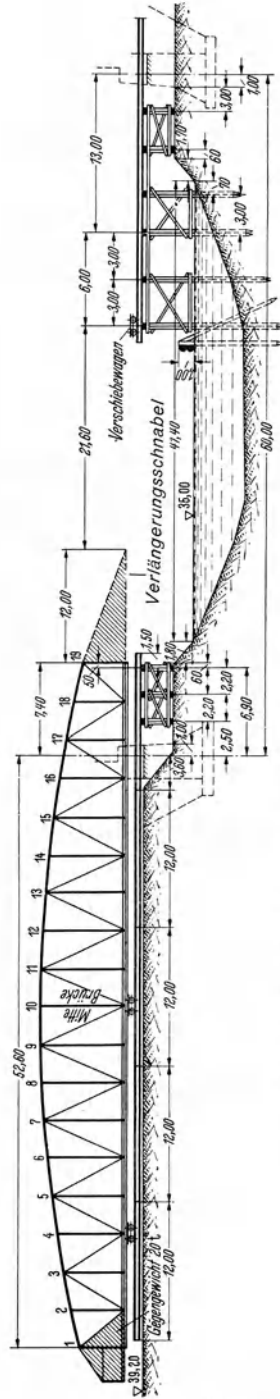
Längsverschiebung einer eingleisigen Eisenbahnbrücke über den Rhein-Herne-Kanal. (Der angesezte dreieckförmige Verlängerungsschnabel am vorderen Brückende ist schraffiert dargestellt.)
